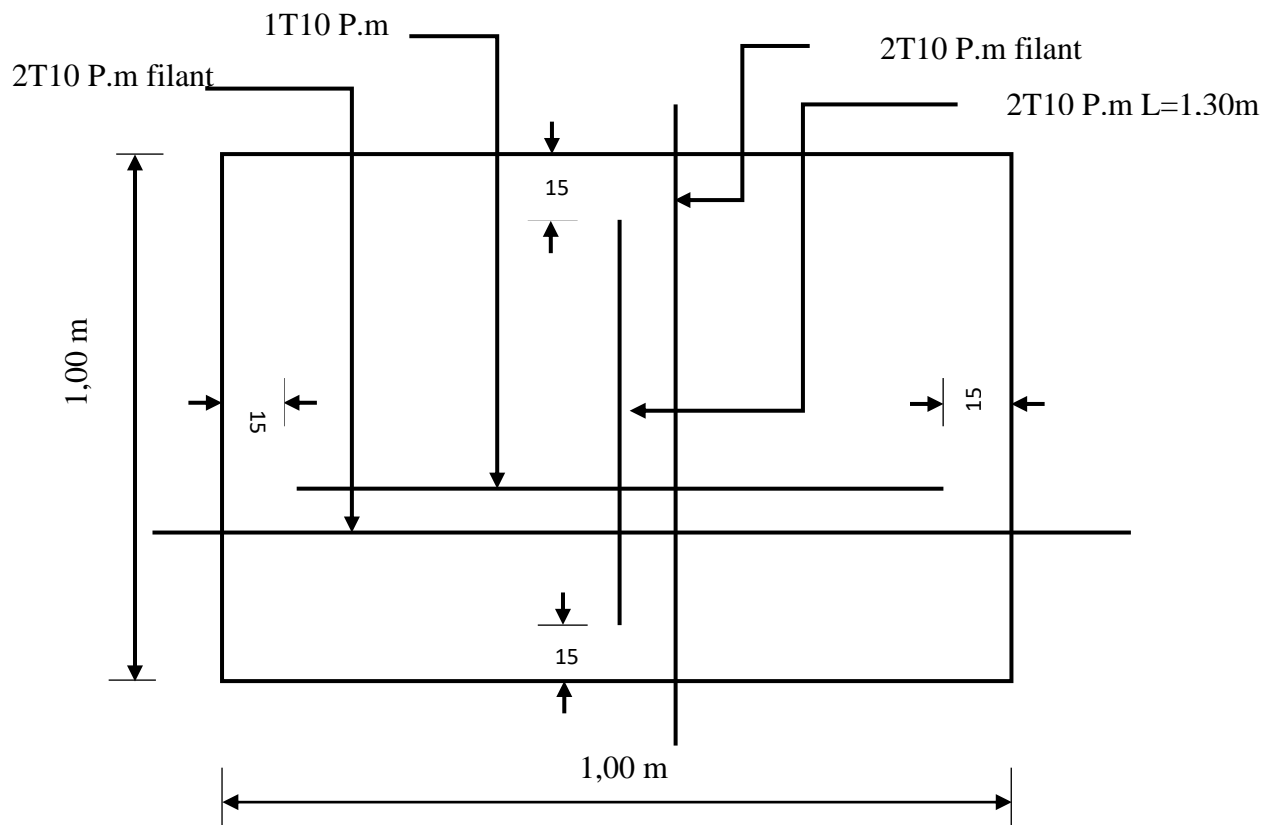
Ferrailage inferieur (travée) du panneau de dalle plein
